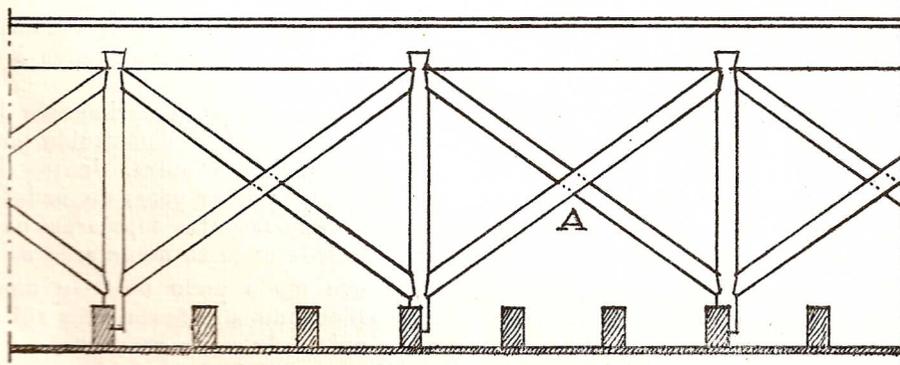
CONTRAVENTAMENTO CONSTRUÍDO COM CRUZES DE SANTO ANDRÉ
